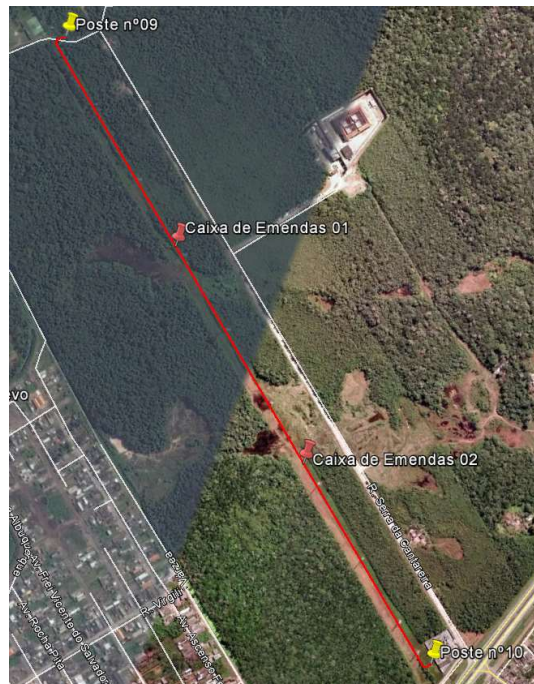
Planta de Localização da LT MAN-MON, trecho subterrâneo.
